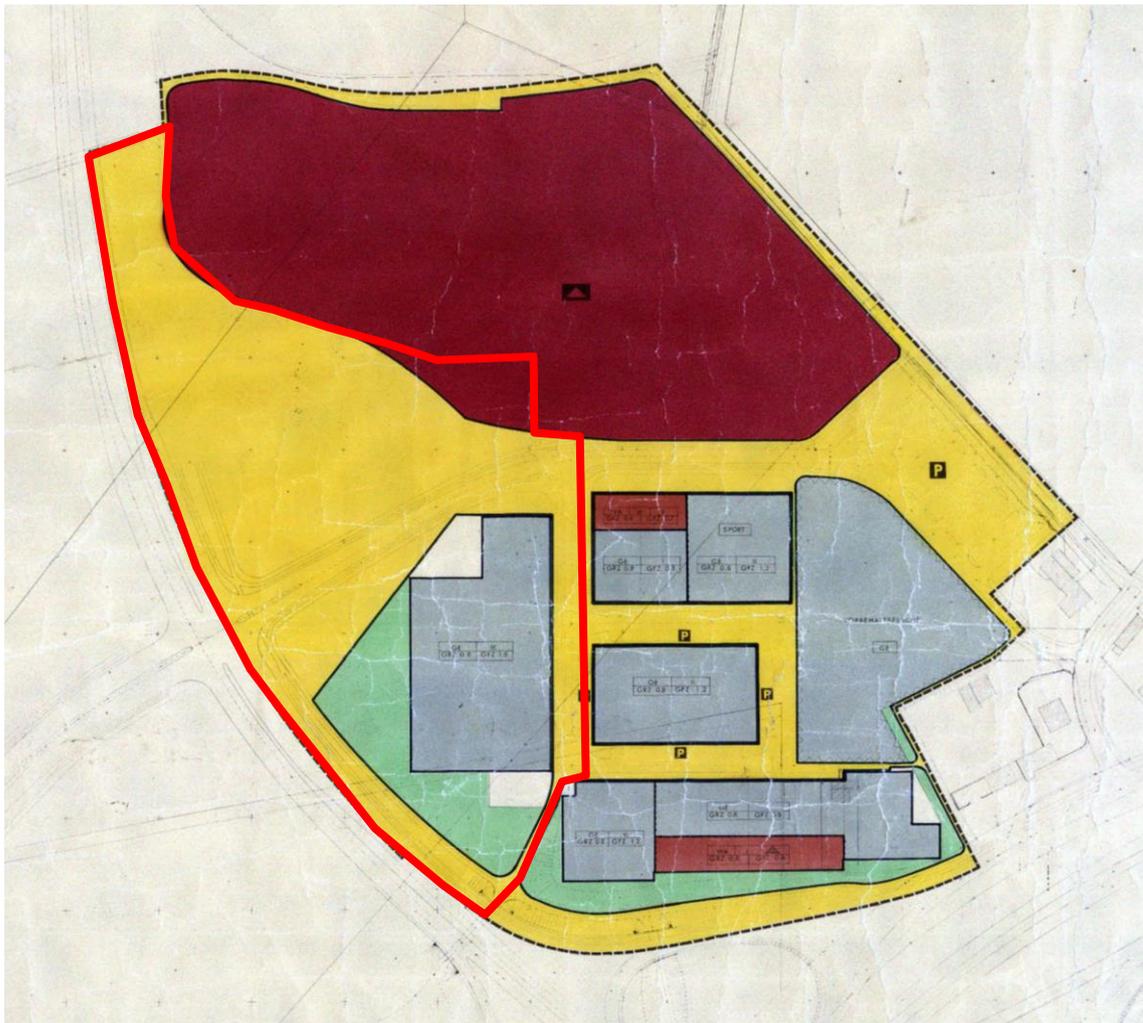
Ursprungsplan mit Abgrenzung des Plangebiets
